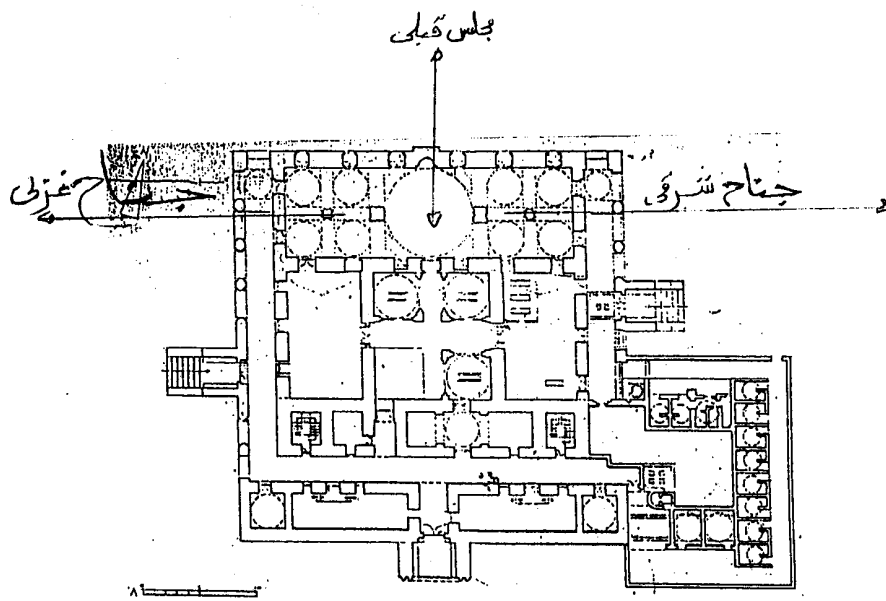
مسقط أفقي لمسجد الاغوات داخل قصر طوبقا بی سراي
